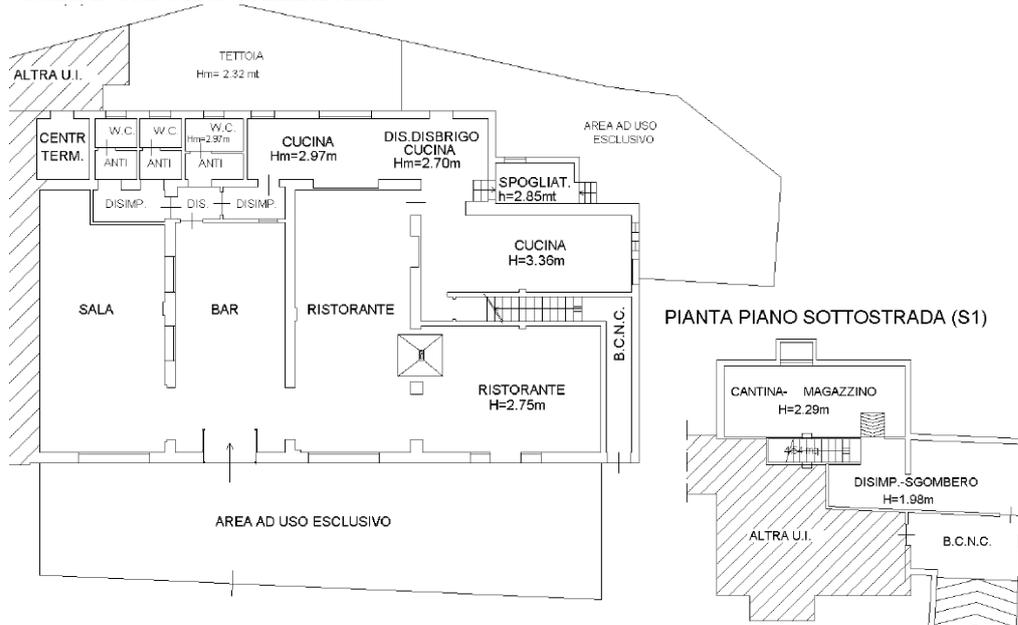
Estratto planimetria catastale, relativa al piano terra
